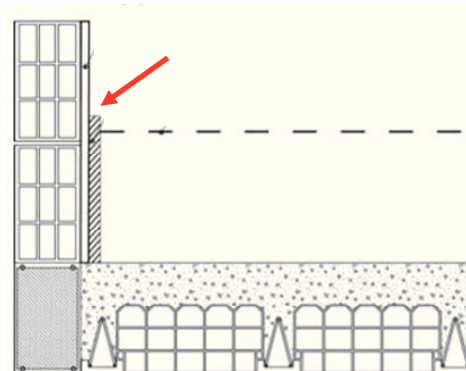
esempio di altezza corretta della fascia perimetrale, oltre l'altezza prevista del solaio finito
